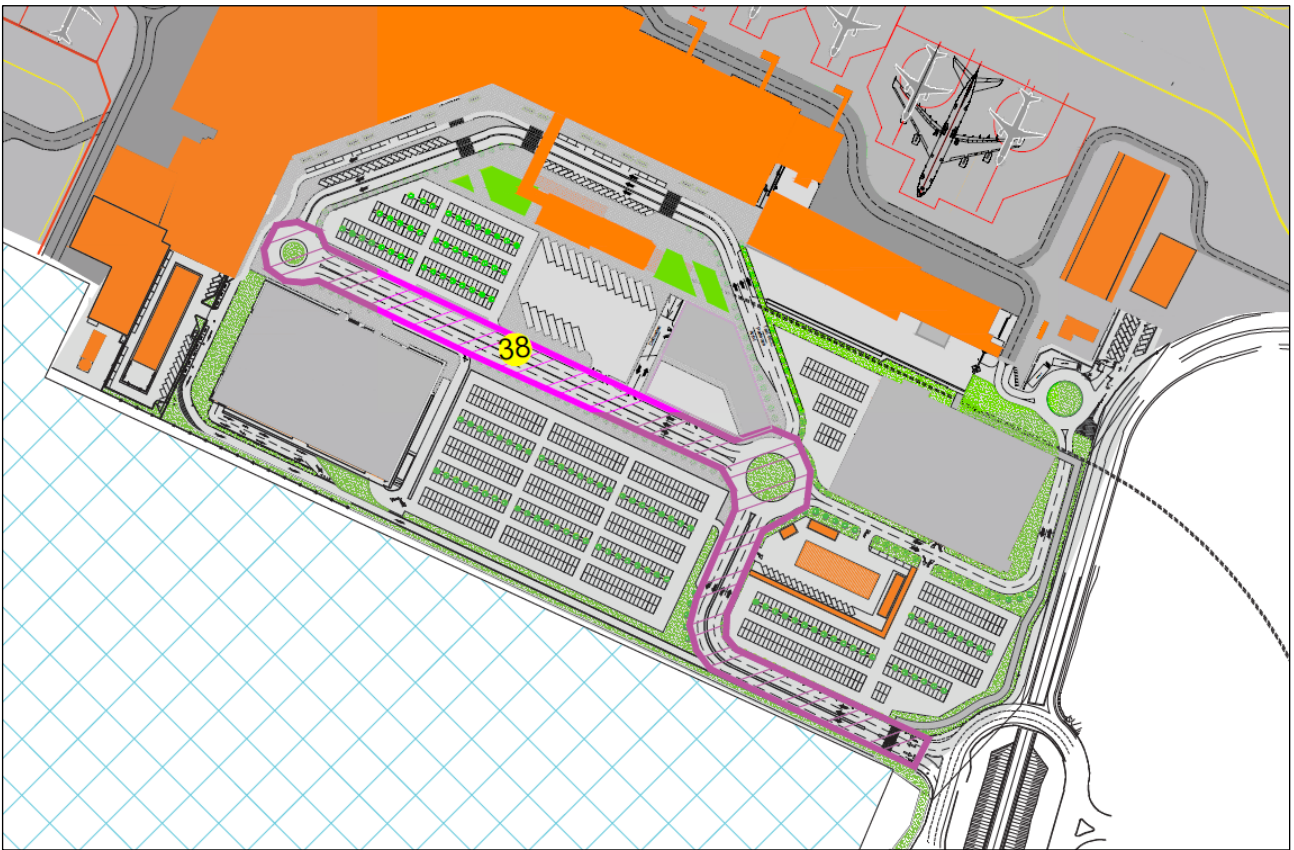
Estratto Master Plan – Nuova Viabilità Landside
